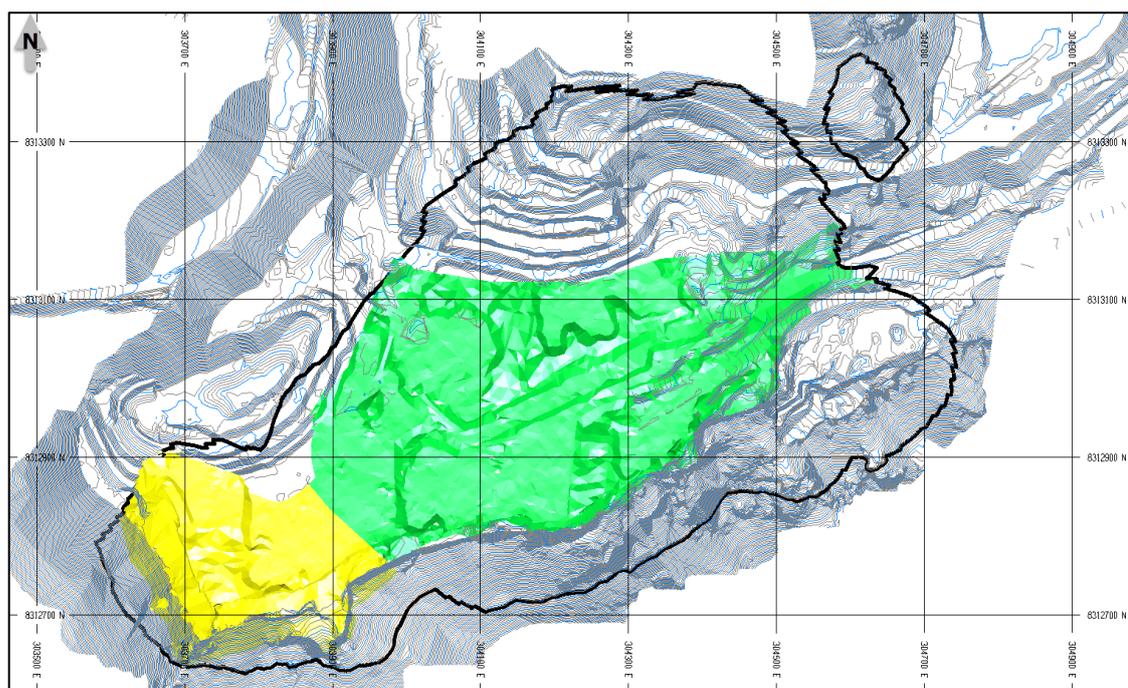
Vista en planta de los sólidos del plan anual 2013
